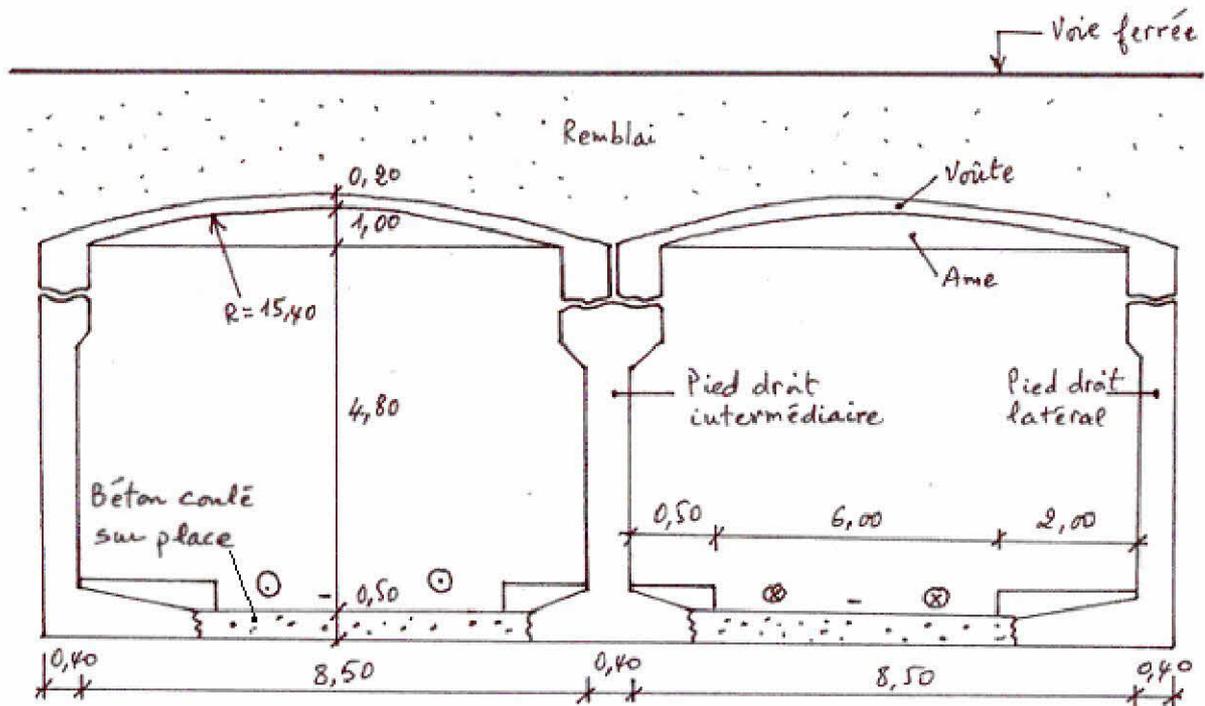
Exemple d'un procédé matière : Passage inférieur sous voie ferrée à Sidi Bel Abbes.
